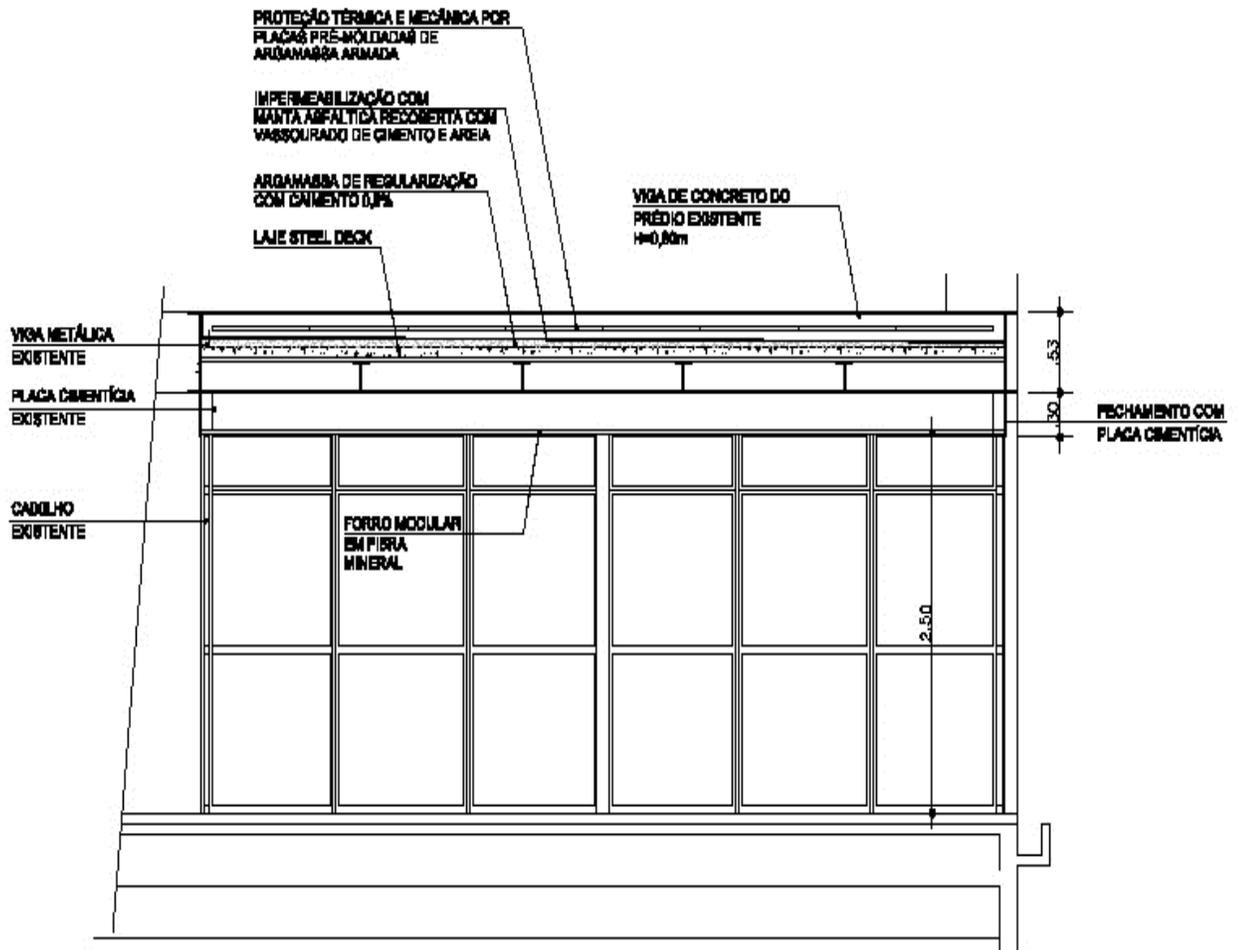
Planta Proposta 01 –Detalhe - Setor Presidência – 1º Pav.
